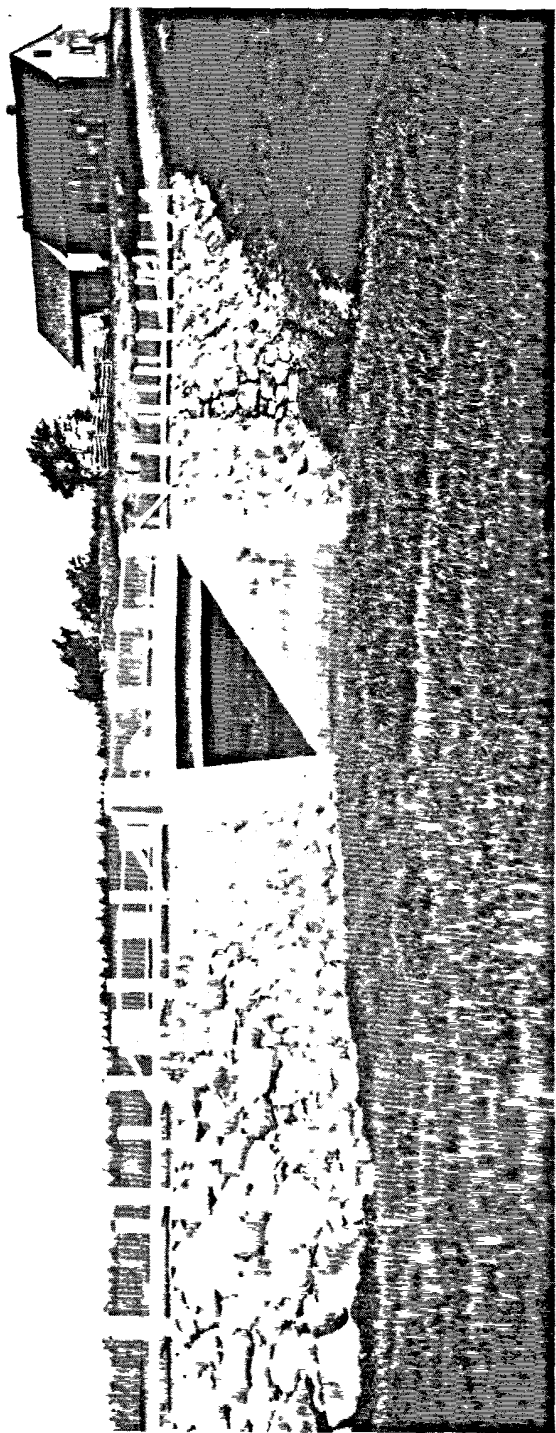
PONT SUR LA RIVIERE AUX PINS A ST-GILLES, COMTE LOTBINIERE. (SUR LE CHEMIN CRAIG).—Ce pont est formé d'une travée de 30 pieds de portée et est constitué par une dalle en béton armé supportée par des poutres en béton armé reposant sur deux culées en béton. Sa largeur de voie charretière est de 20 pieds. Construit en 1934.
